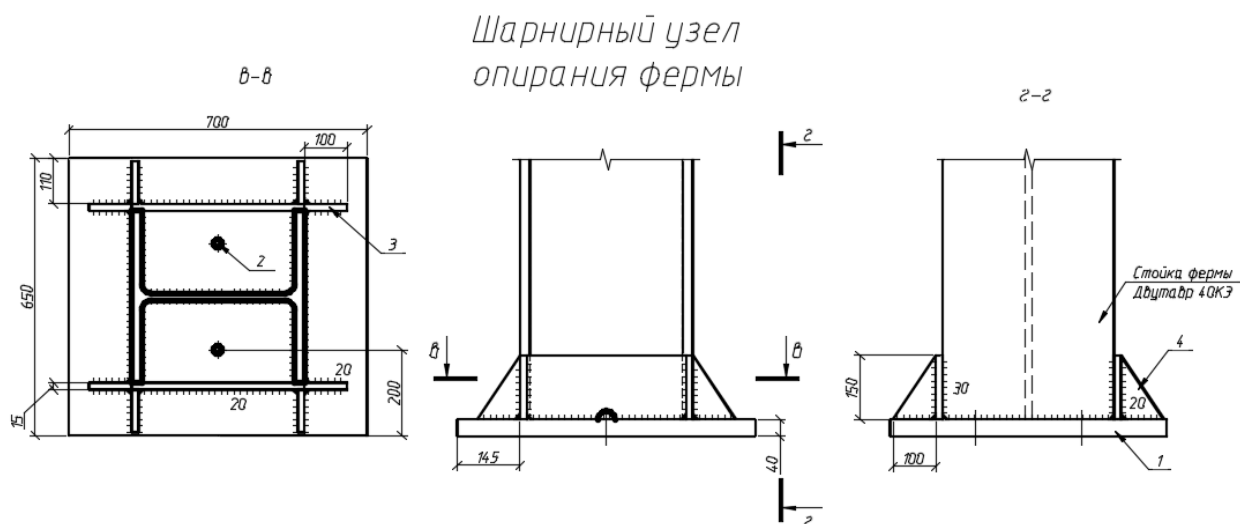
Шарнирный узел сопряжения опорной стойки фермы с железобетонным поясом
